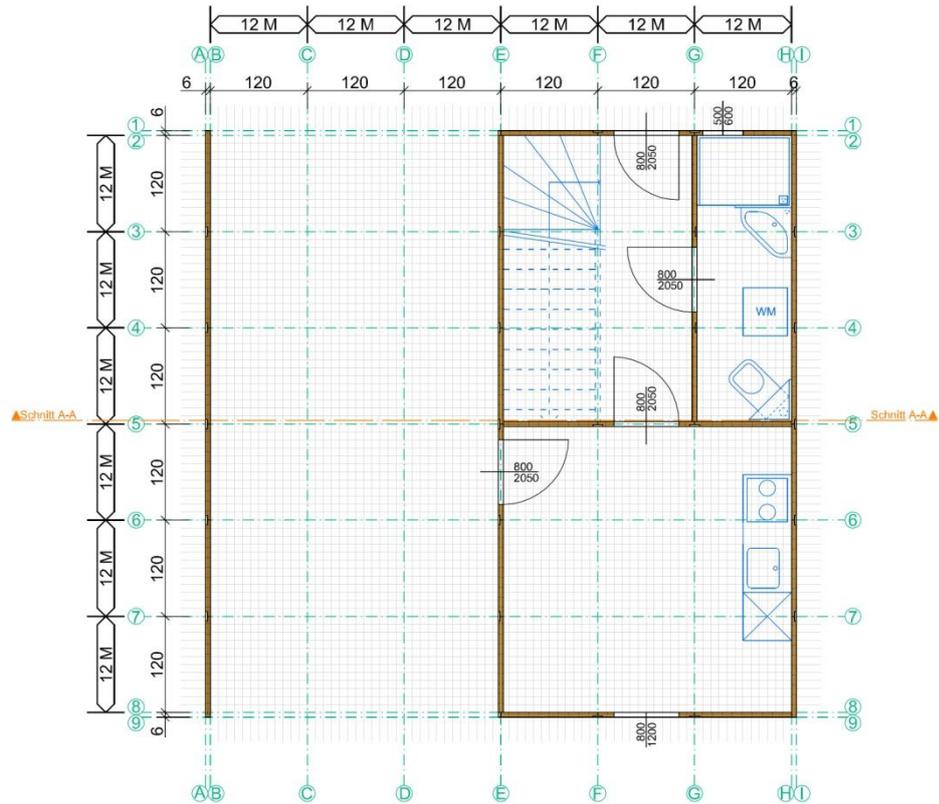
Grundriss des Erdgeschosses in der Grundstufe
